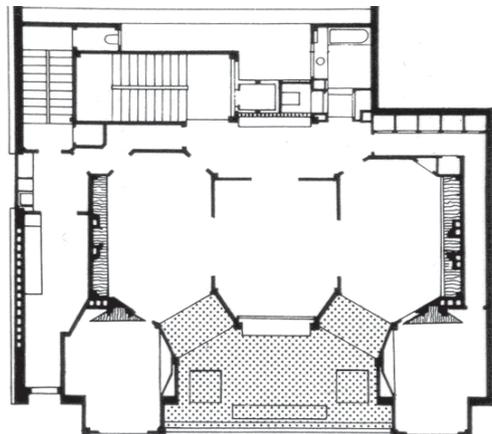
Planta baixa do segundo pavimento. (CURTIS, 1996, p.78).
